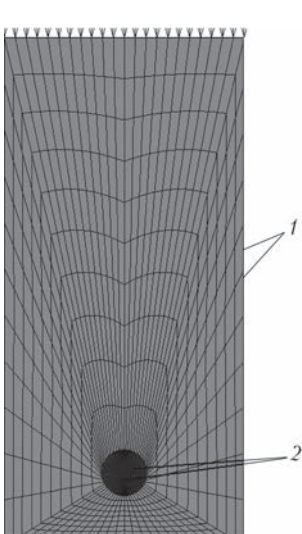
Поперечний переріз бетонної балки (1) із вмонтованою арматурою (2)
